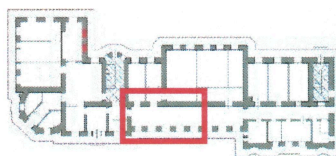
Междуэтажные плоские перекрытия, кирпичные перемычки оконных, дверных проемов
